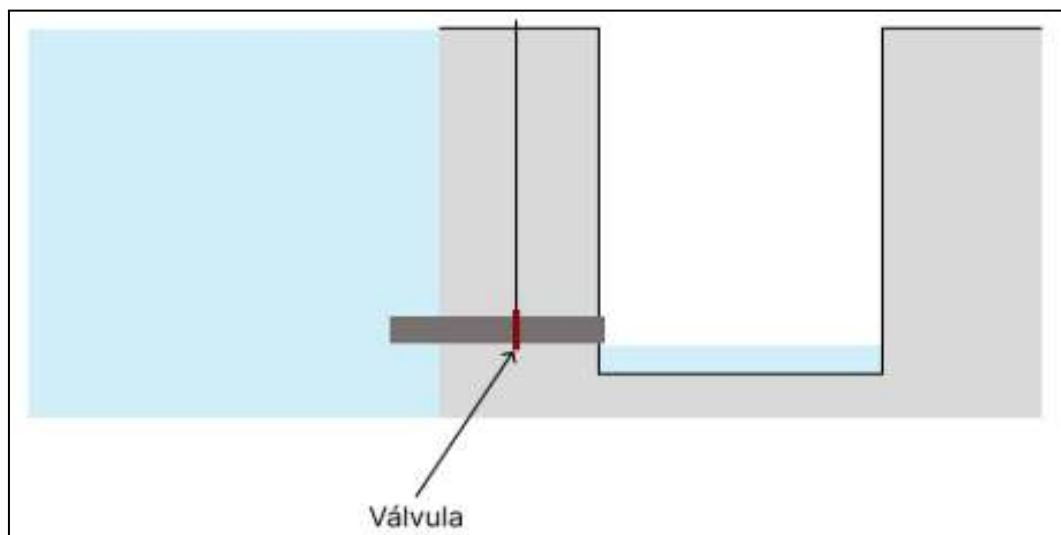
Vista frontal de piletón con válvula en cañería
